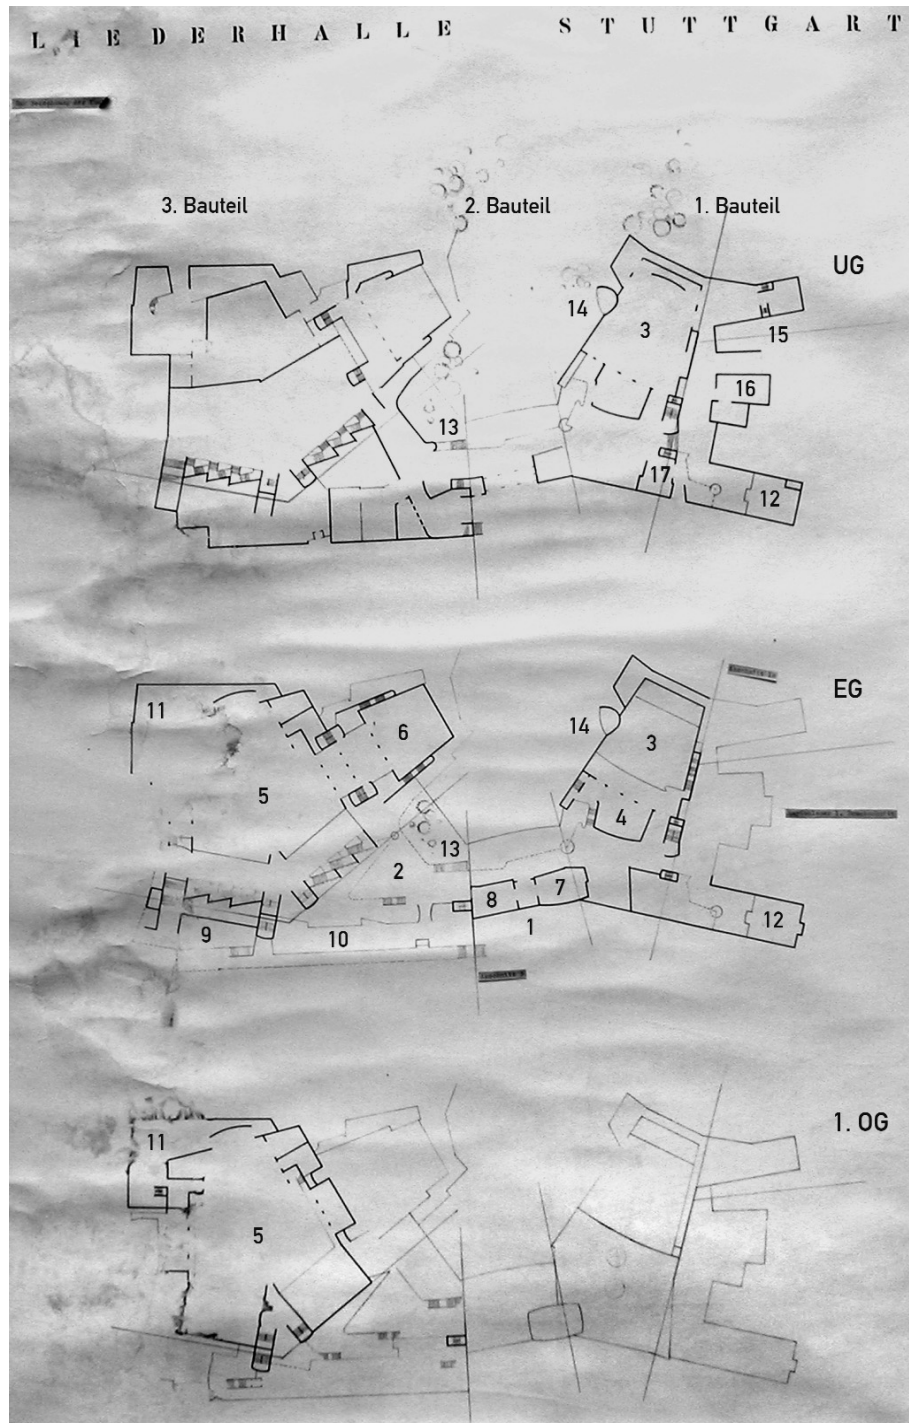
Grundrisse, Scharoun, 1949: Untergeschoss, Erdgeschoss, 1. Obergeschoss.
